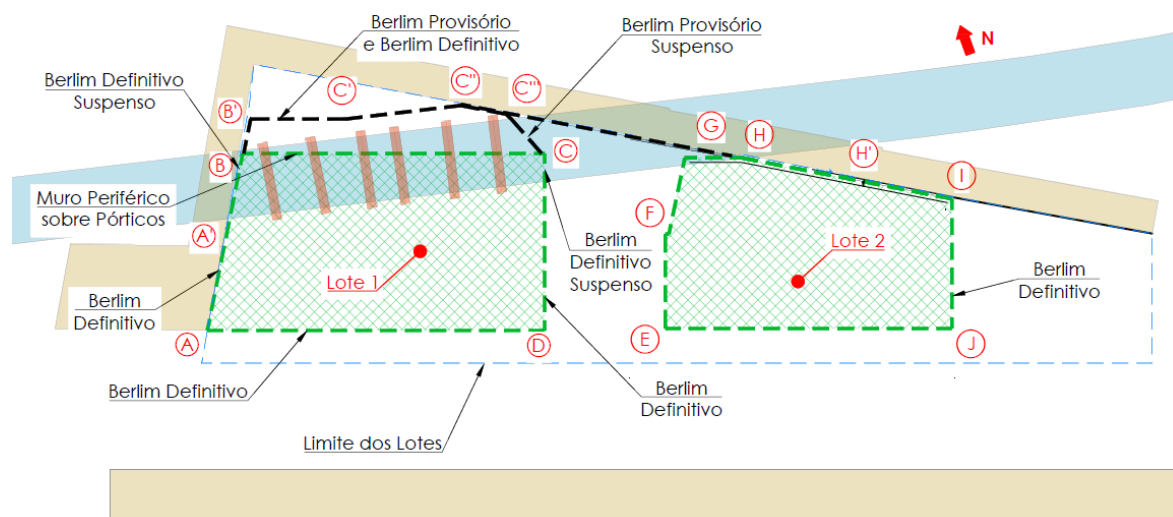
Planta esquemática das contenções periféricas (adaptado de JET_{SI}, 2021).
